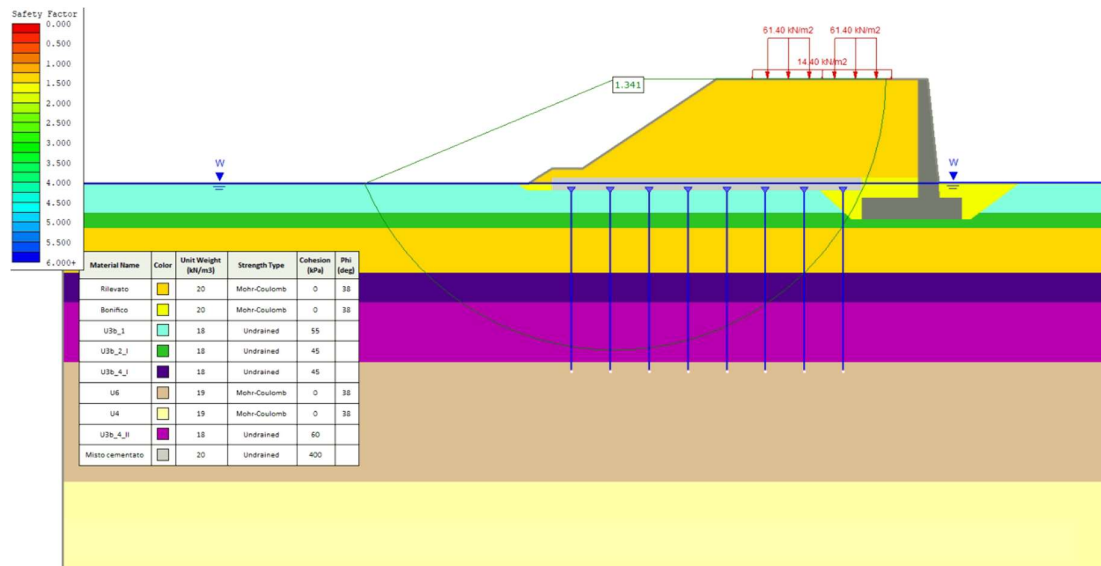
Sezione B - Analisi SLU in campo statico DA1C2
